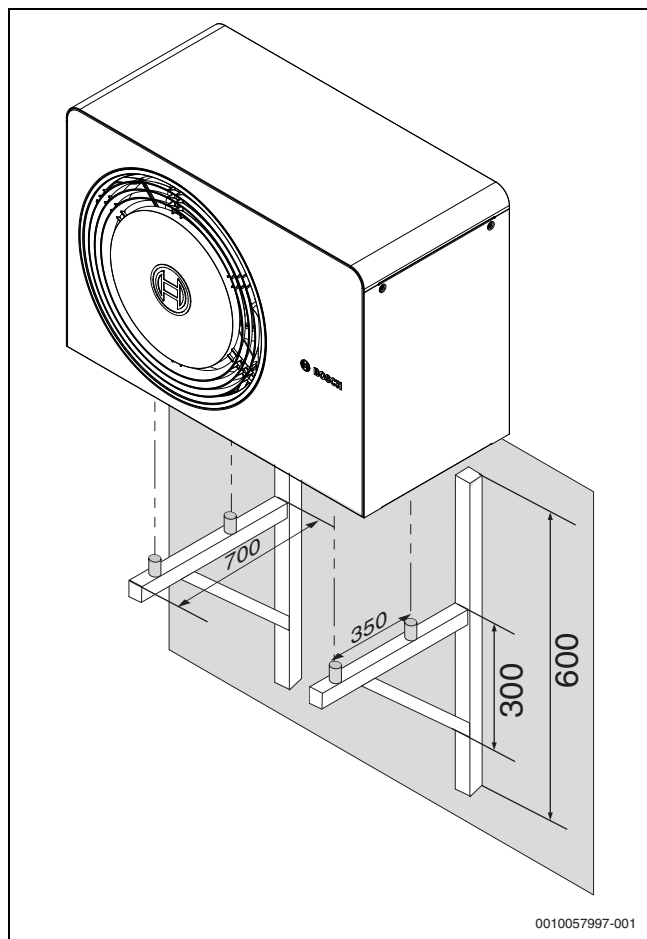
Abmessungen Wandkonsole (Maße in mm)
